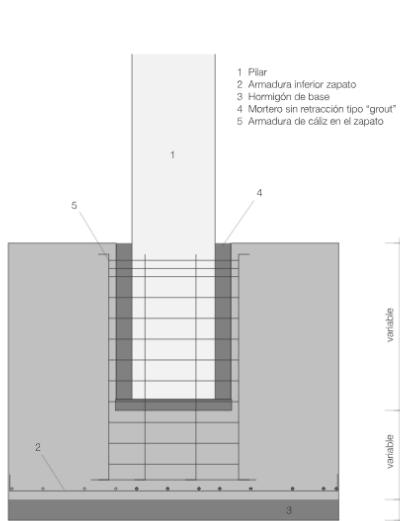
Detalle constructivo de la zapata de cáliz [13]
